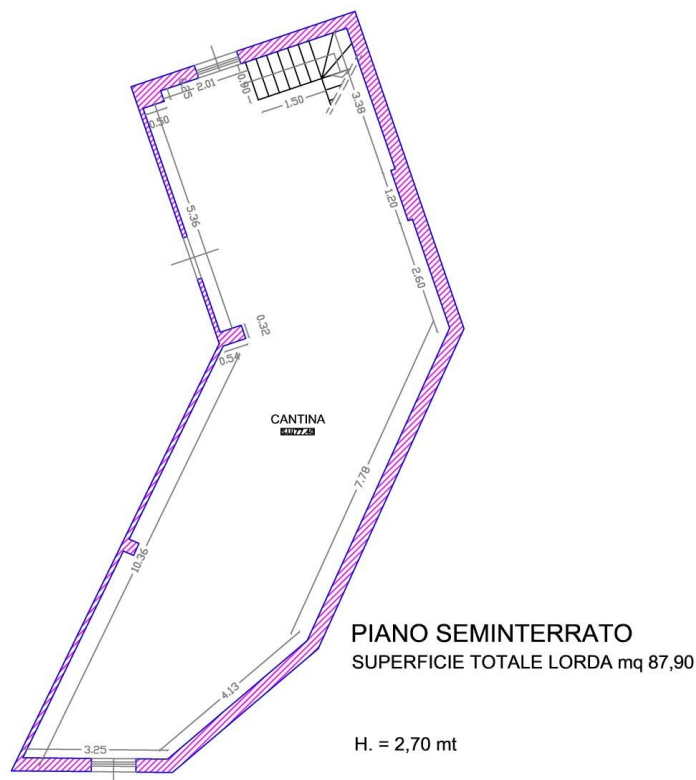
Pianta del locale commerciale dopo rilievo primo accesso
